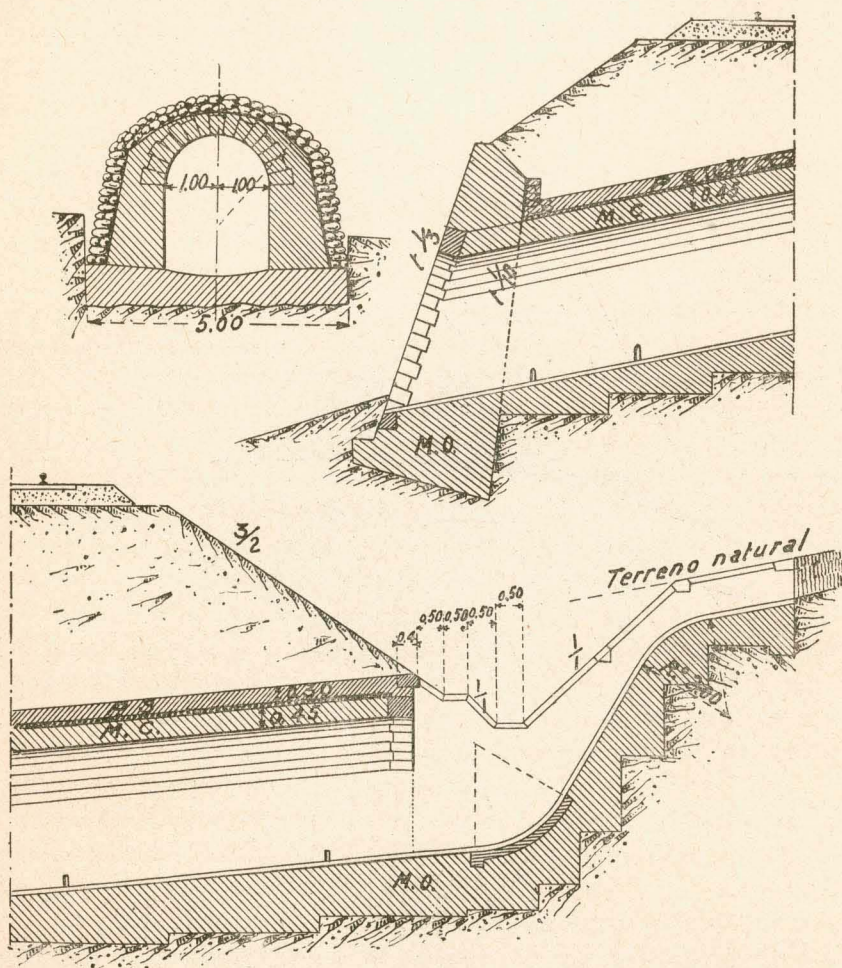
Alcantarillas en pendiente del ferrocarril de Tánger a Fez
